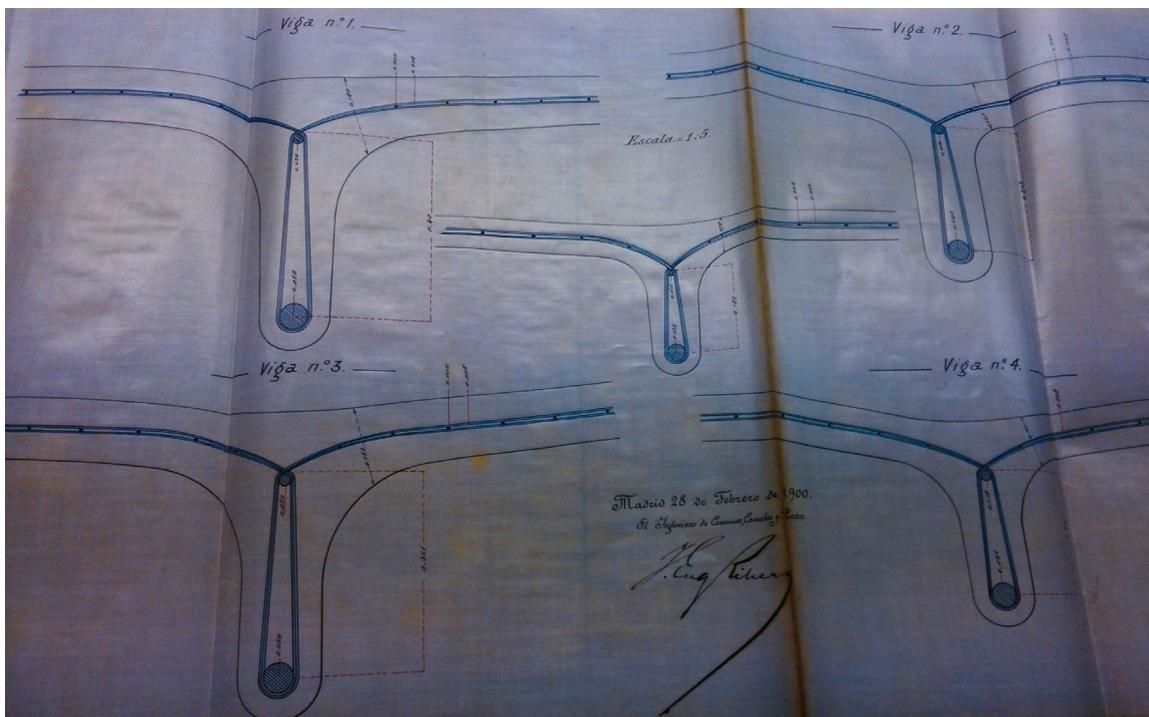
Detalle de los planos de la solución de depósito circular sistema Monier, una de las planteadas por Ribera para el nuevo depósito de Llantones, Gijón. 1900. Archivo Municipal de Gijón.
